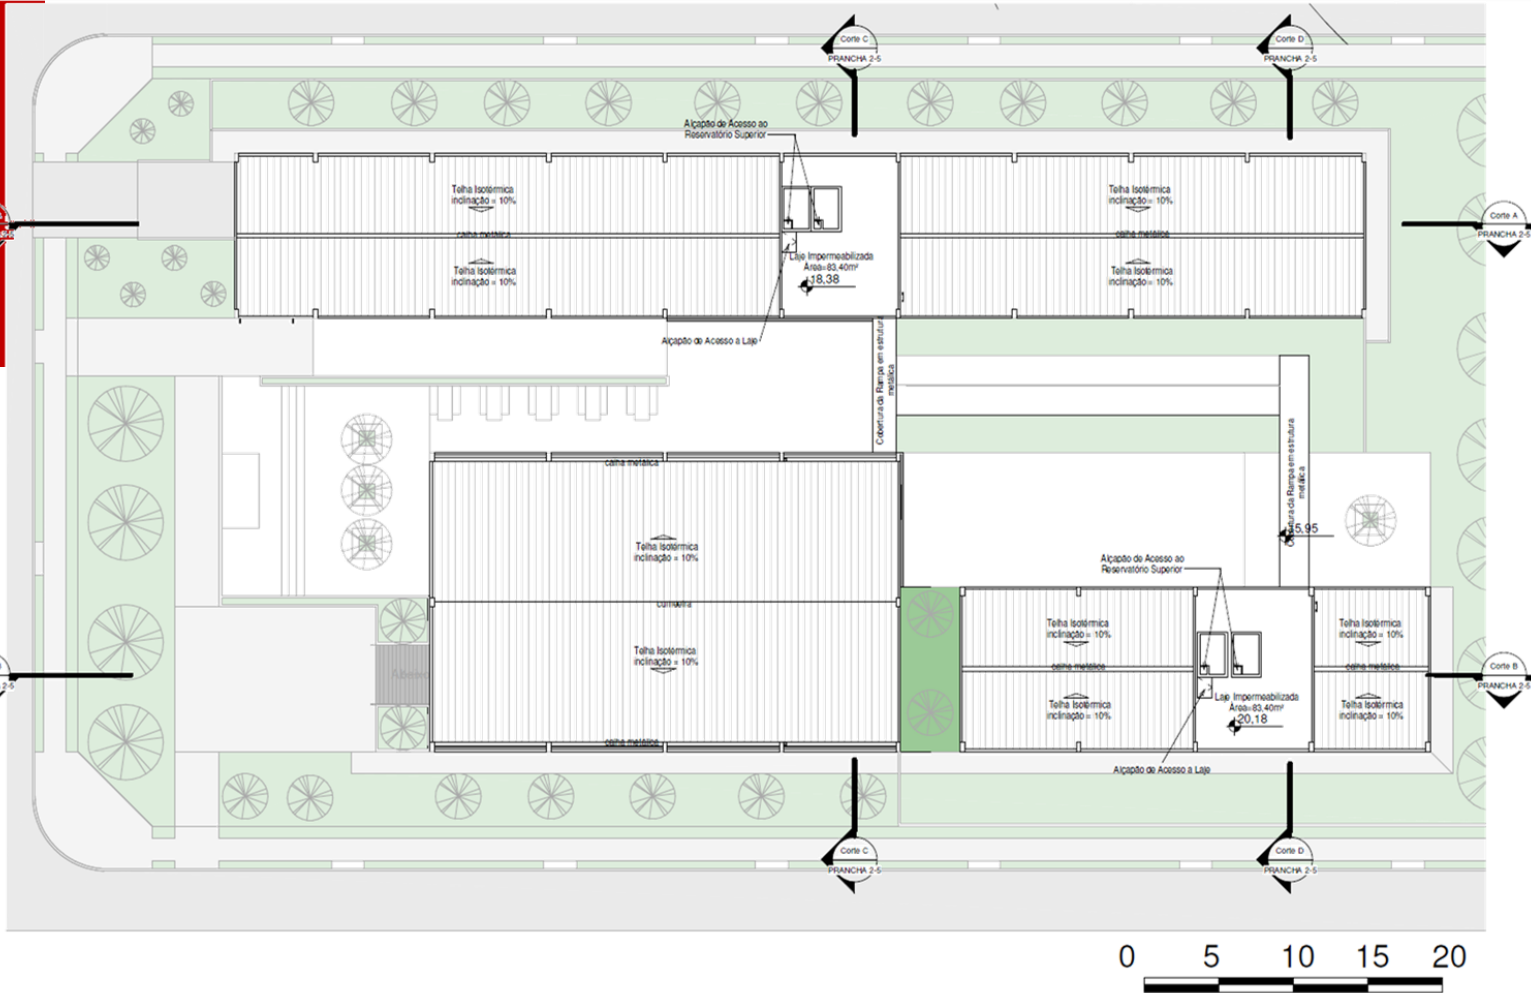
Planta Baixa da Cobertura. Feito no Revit.
